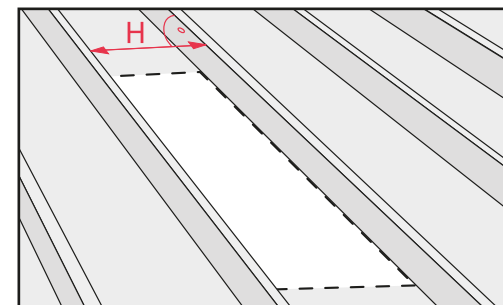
P. Mida la longitud "H" del travesaño entre las vigas del techo.
